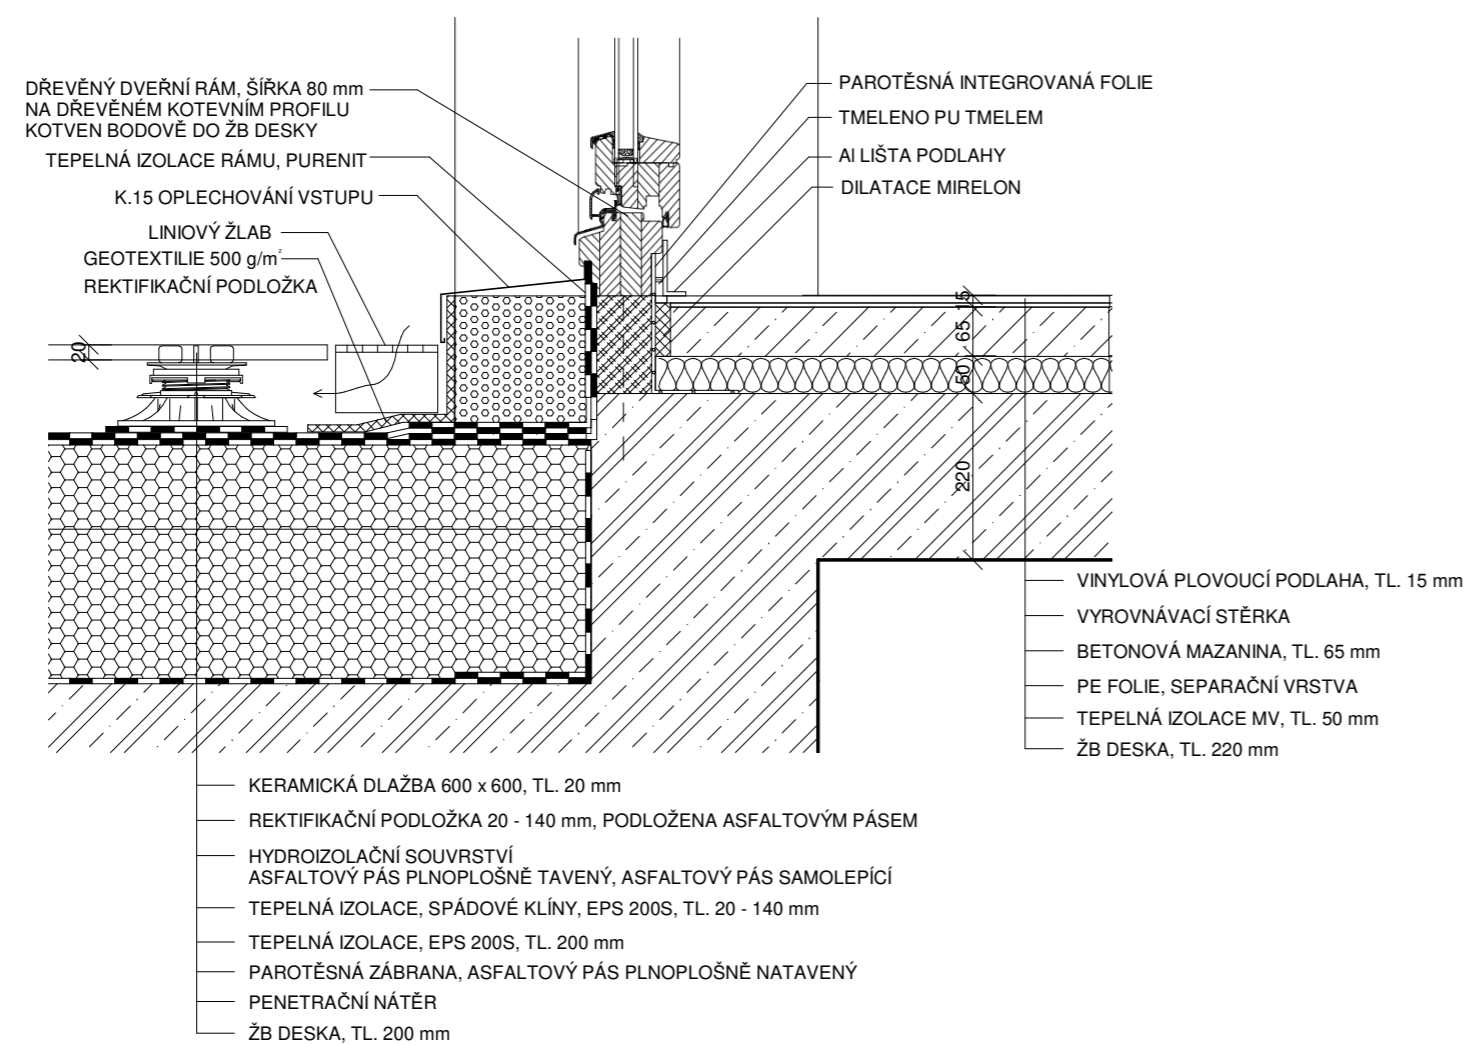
DETAIL ODVODNĚNÍ PLOCHÉ POCHOZÍ STŘECHY DET. 4
